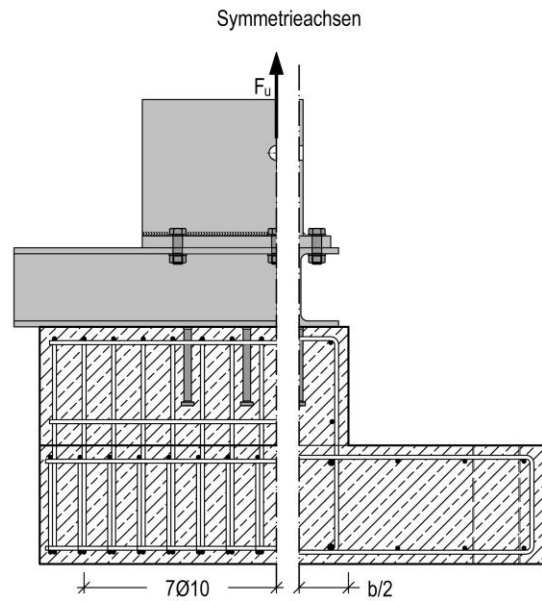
Schematischer Bewehrungsplan des Versuchskörpers R-04
